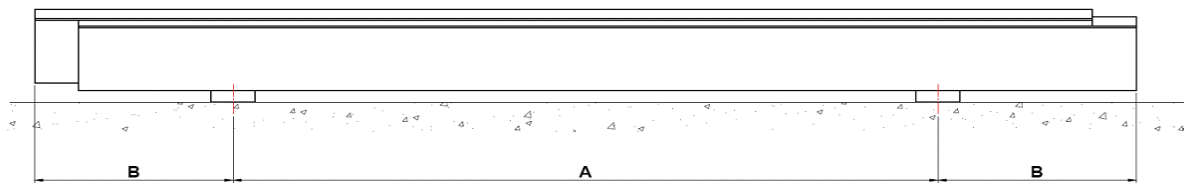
Croqui de apoios de empilhamento Fonte: ABNT NBR 7196.
